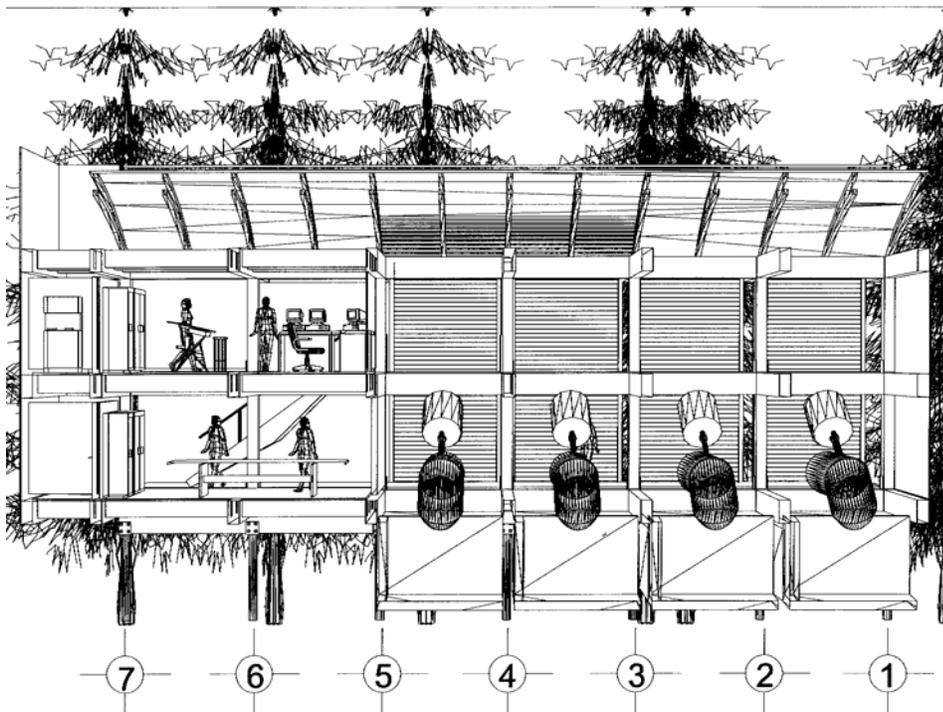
El taller y cuarto de turbinas en Planta Baja. Arriba se encuentra el cerebro con un “coffee station”.
